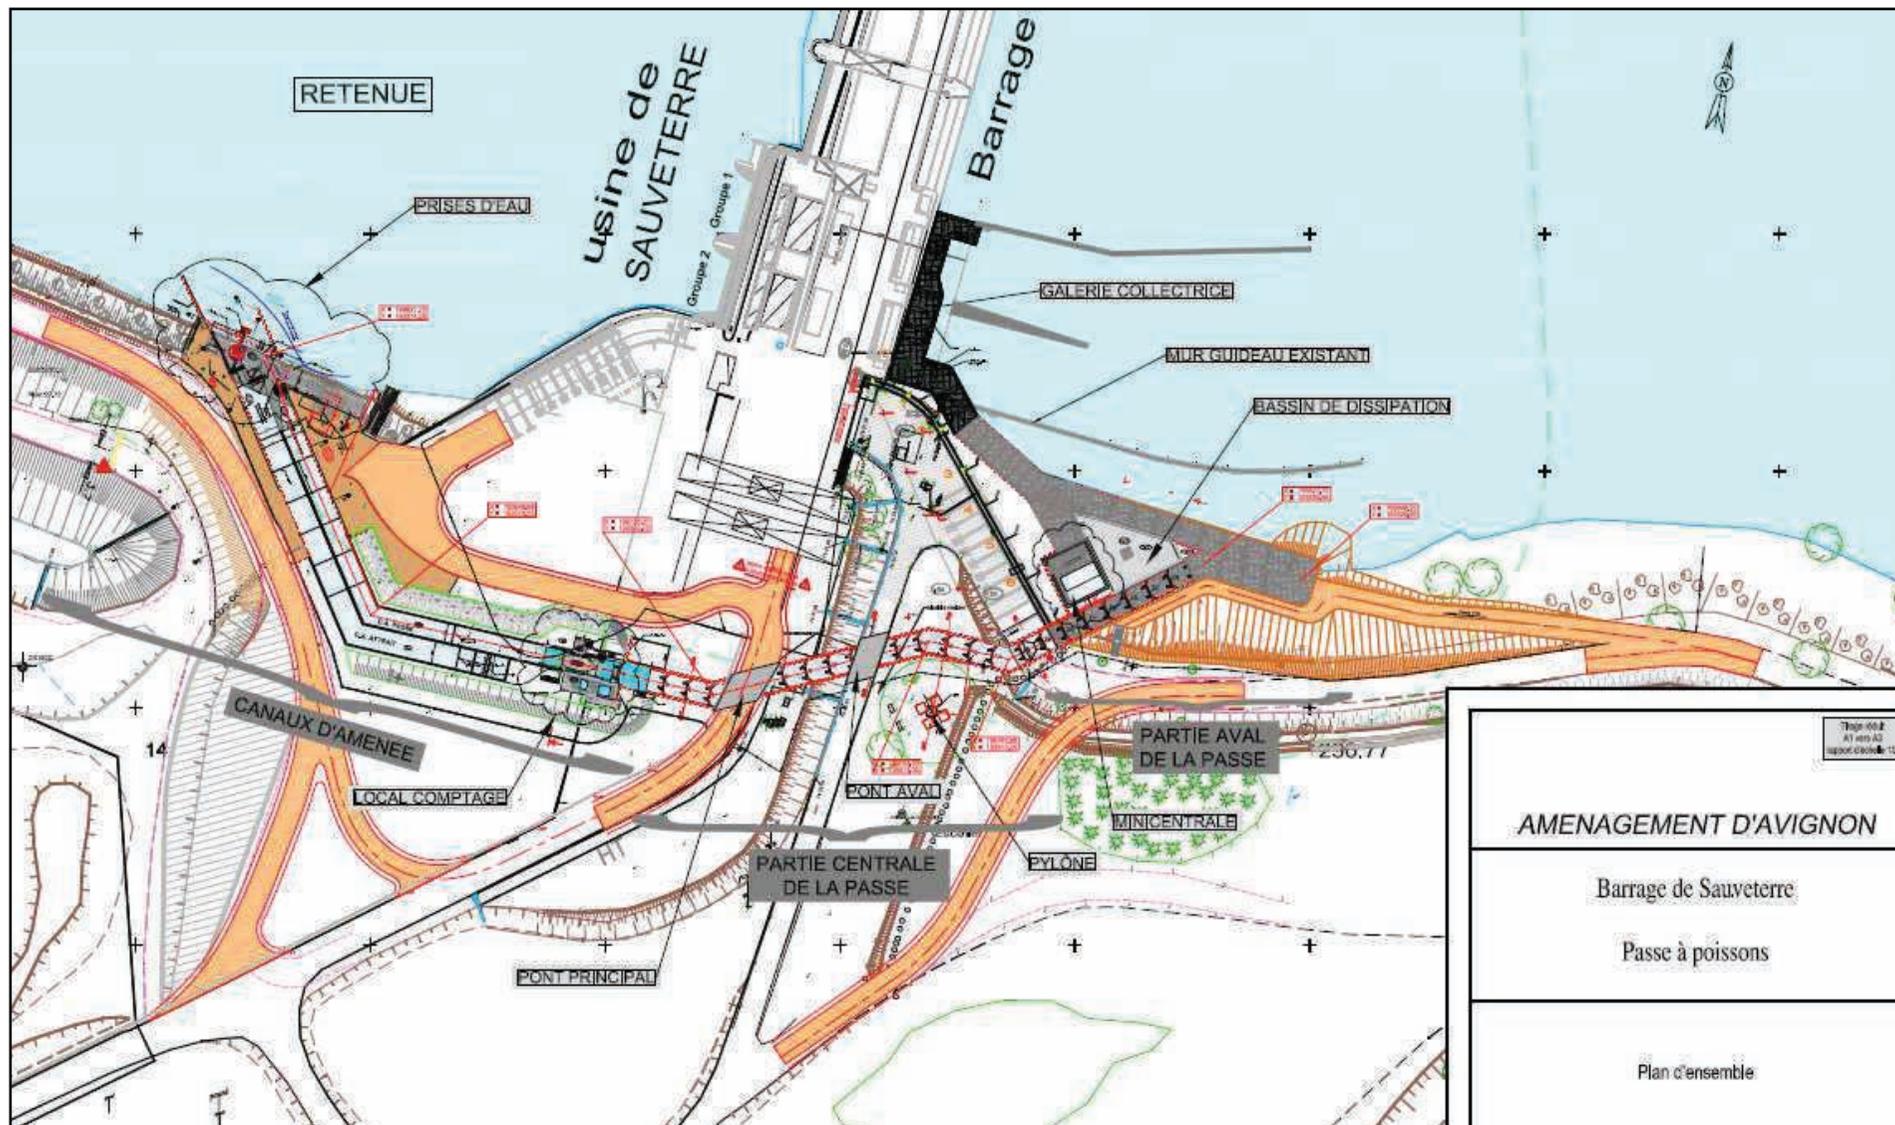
Plan d'ensemble du projet de passe à poissons sur le barrage-usine de Sauveterre – CNR, 2013.
